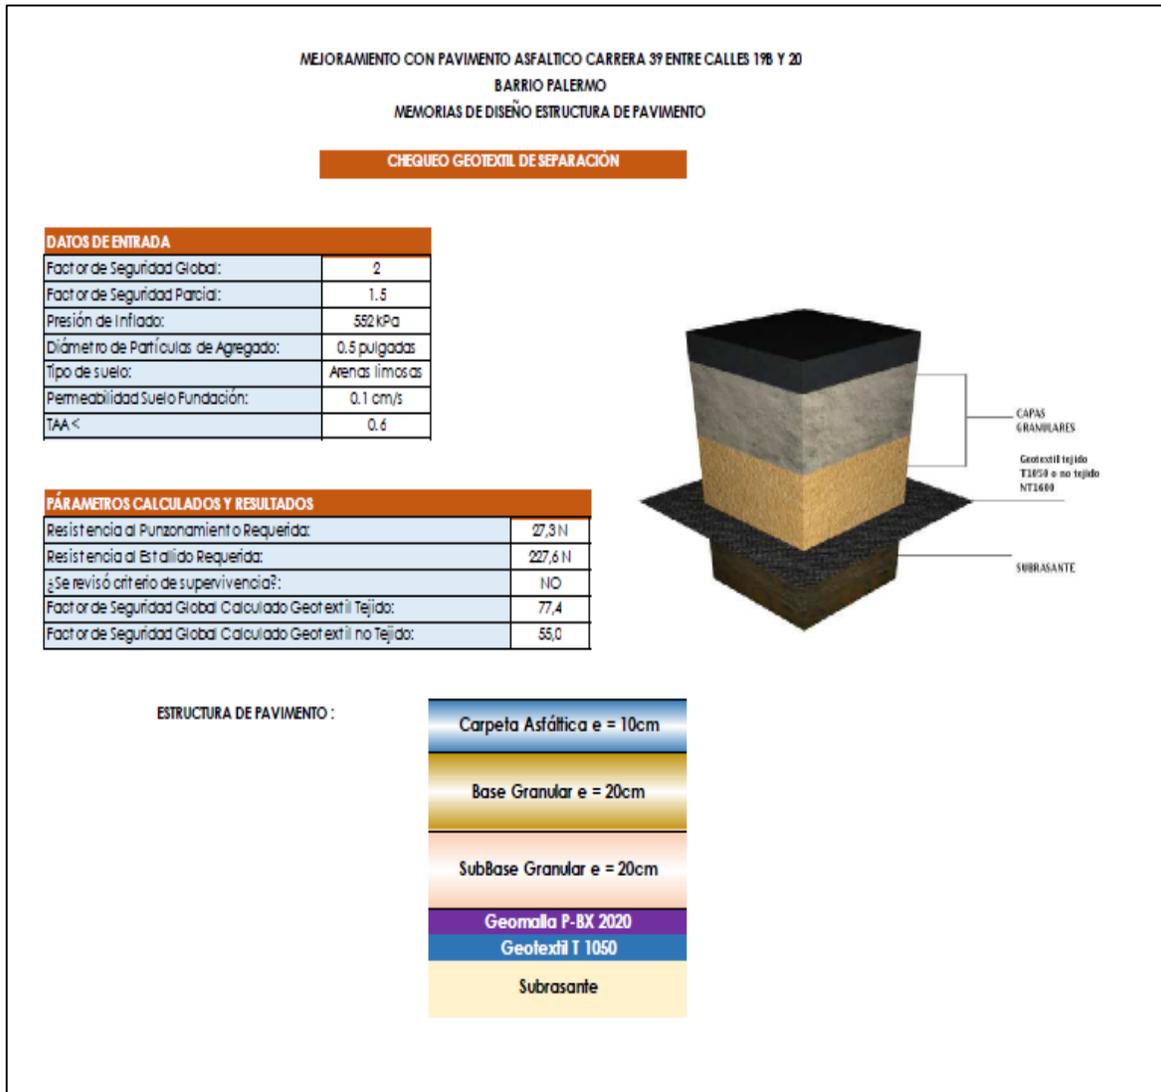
Diseño estructural de pavimento asfáltico con geomalla.
